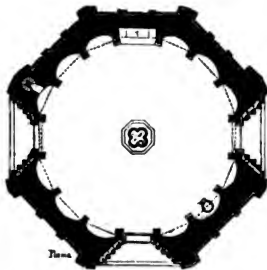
Grundriss des Baptisteriums von Parma. (Nach Osten.)
